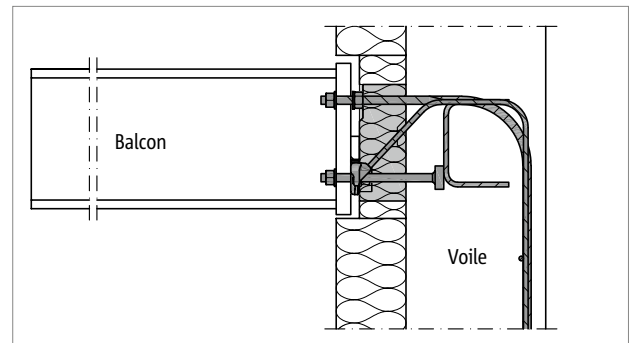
Schöck Isokorb® T type SK-WU-M1 : Construction spéciale pour raccordement mural basé sur le niveau de charge principale M1 pour des épaisseurs de paroi à partir de 200 mm
